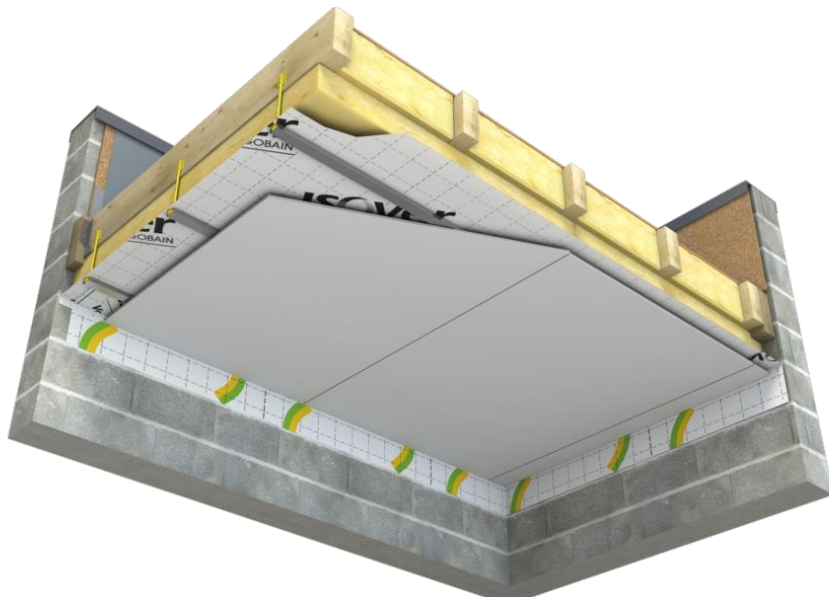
Zoom sur la continuité des membranes du mur et du plafond
